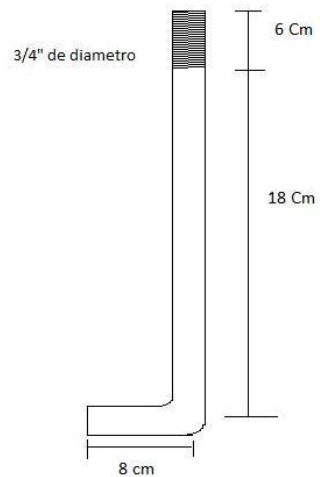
Detalle de armado de hierro dentro de la fosa
